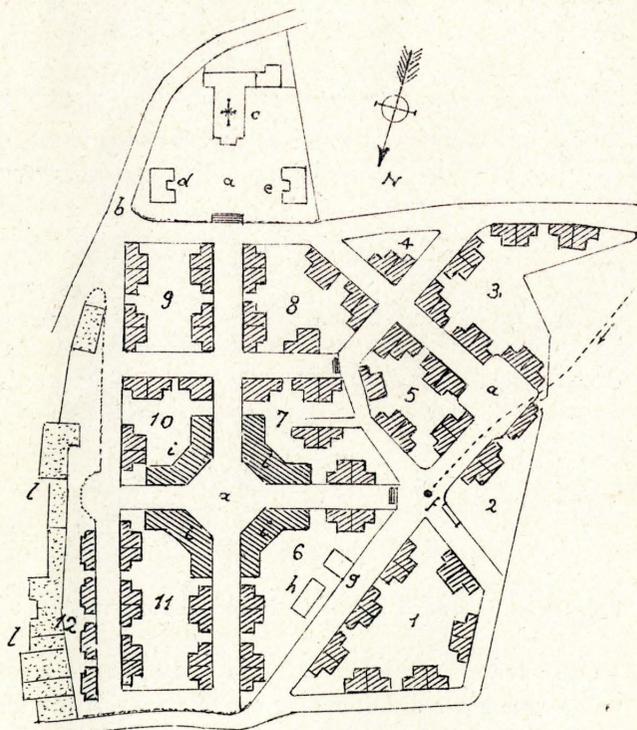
Schema planimetrico di Favèlloni-Piemonte - 1 : 2500.
